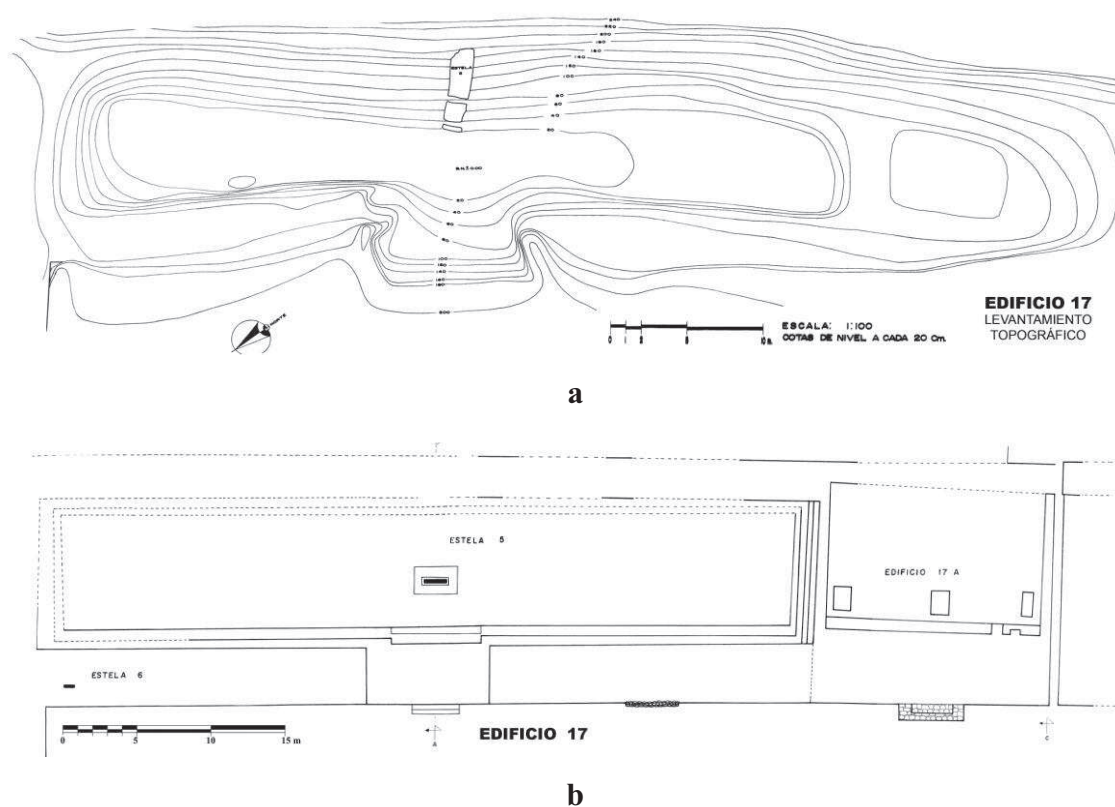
, levantamiento topográfico del edificio 17 antes de su excavación; figura 5.8b, levantamiento arquitectónico al final de la restauración.
